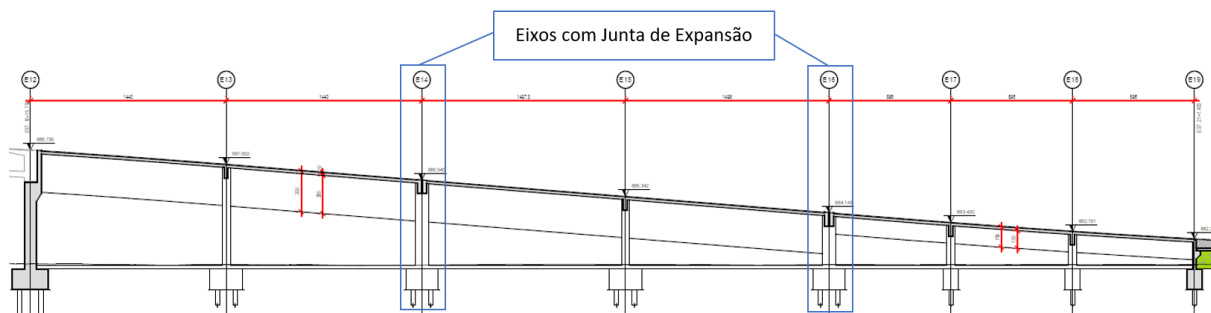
ELEVÇÃO ENCONTRO ESTRUTURADO (EIXOS E12 A E19)
